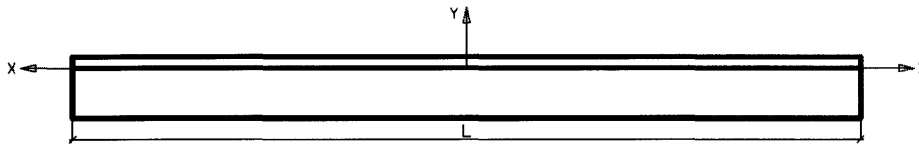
Продольная схема деревожелезобетонной балки с принятой системой координат
